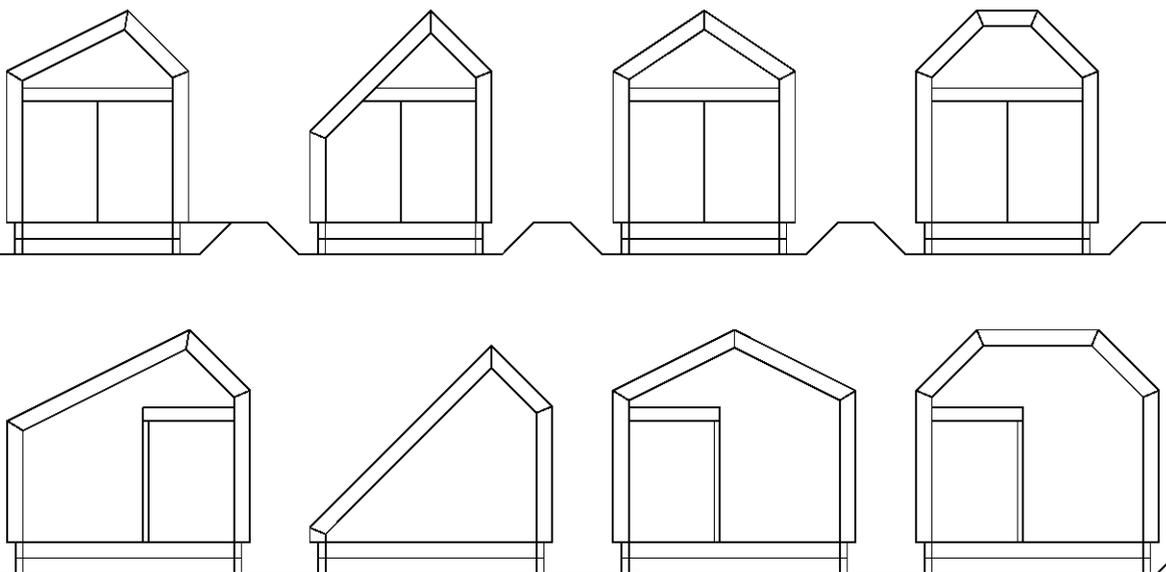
Dachformvarianten ausgehend von einem rechteckigen Grundriss von 3x4m
